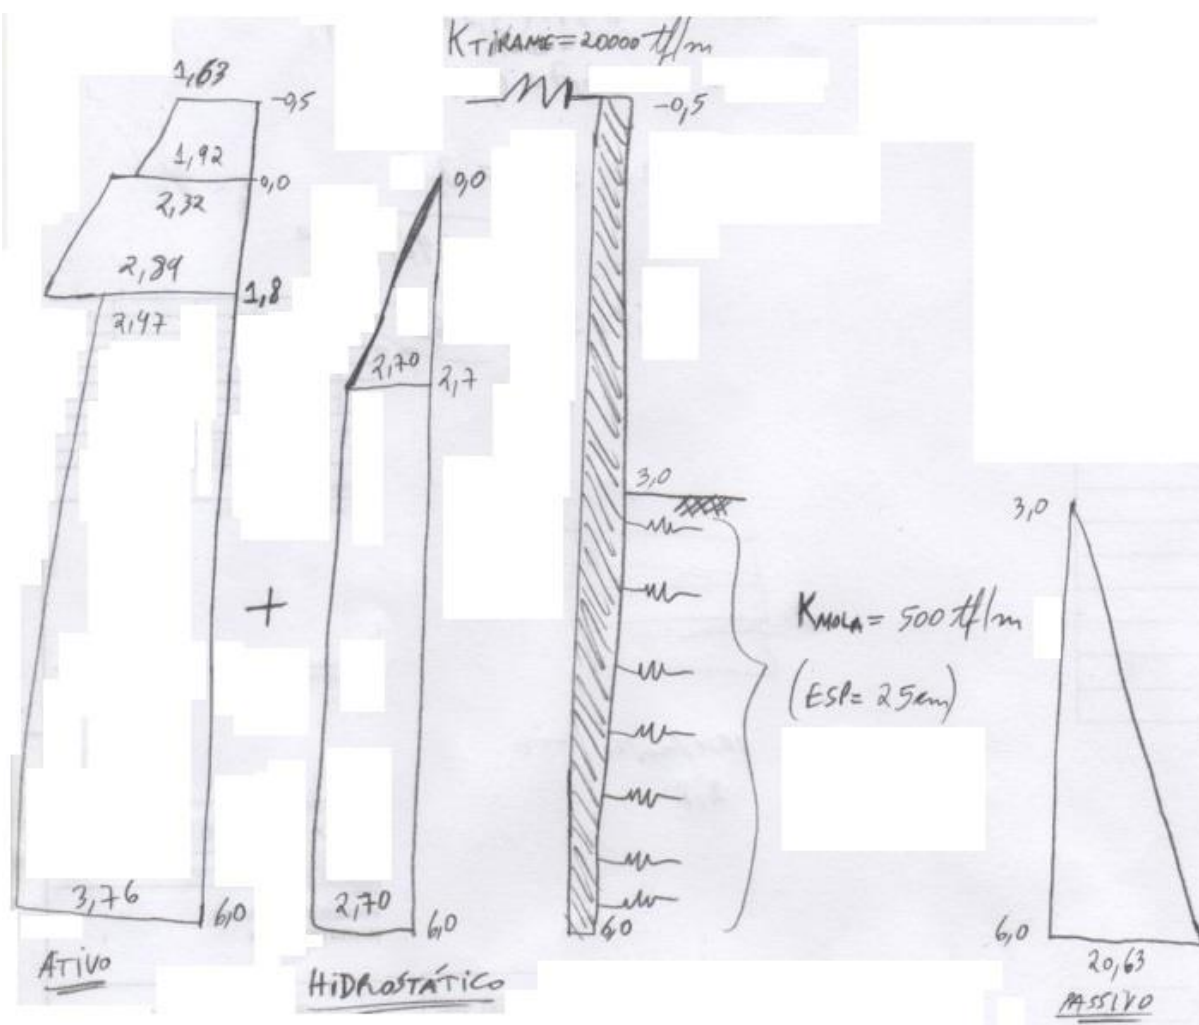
Croqui do modelo estrutural e dos carregamentos (tensões em tf/m² e medidas em metros).
